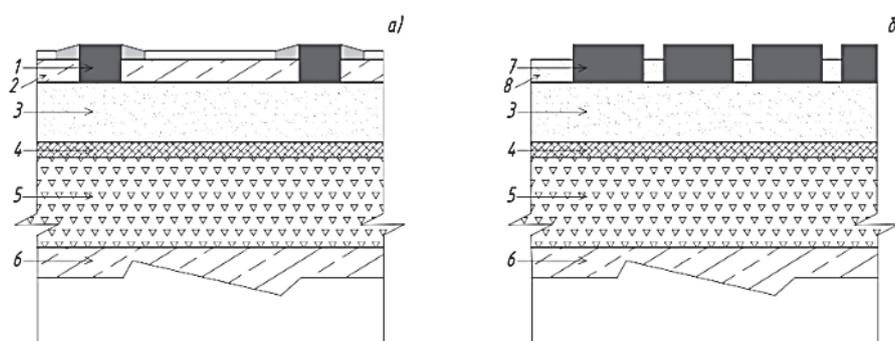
Схема а) экопарковки и б) стоянки с тротуарной плиткой: 1 – газонная решетка; 2 – грунт; 3 – песок; 4 – геотекстиль; 5 – щебень; 6 – грунт основания; 7 – тротуарная плитка; 8 – сухая смесь
